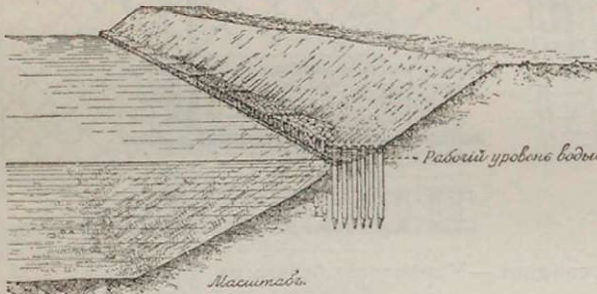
Типъ № 2. Укрѣпленіе подошвы надводнаго откоса плетневыми заборамн съ анкерами.
